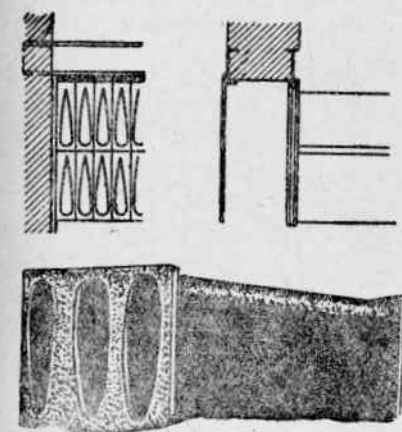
Трубчатый воздухоподогреватель Фёге. Материал—чугун.
